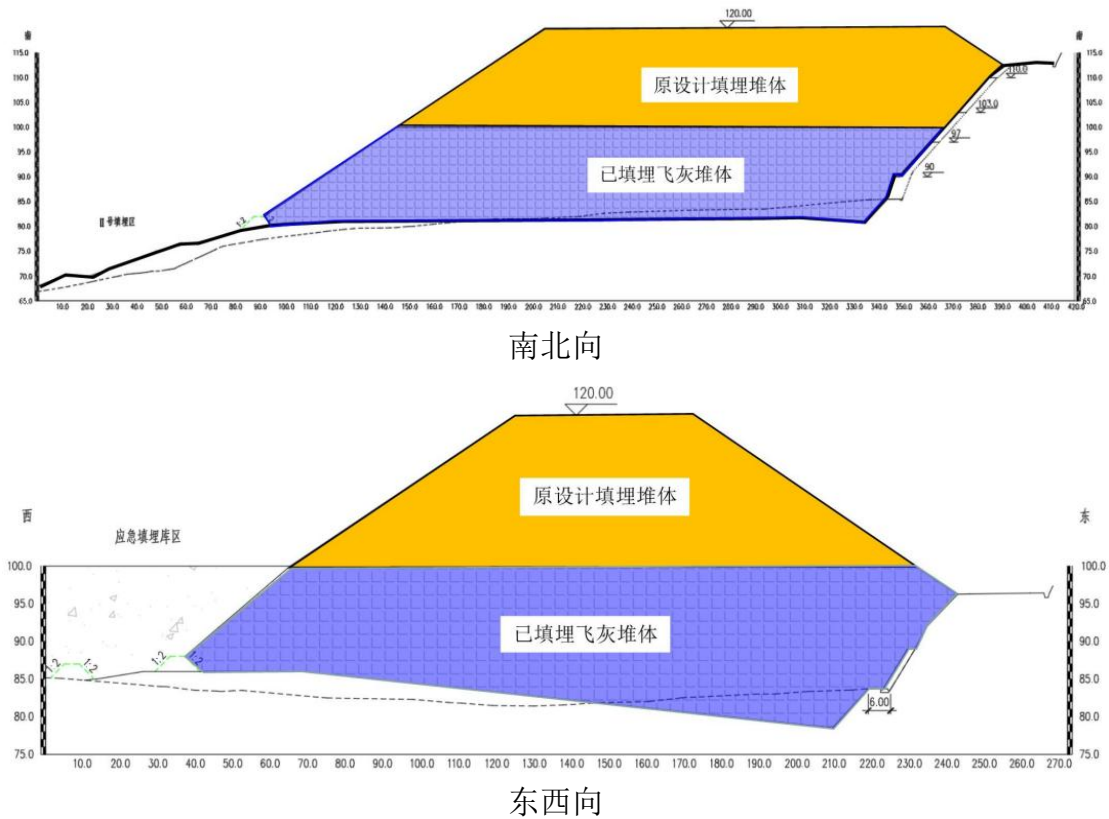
飞灰库区保留填埋堆高剖面示意图
